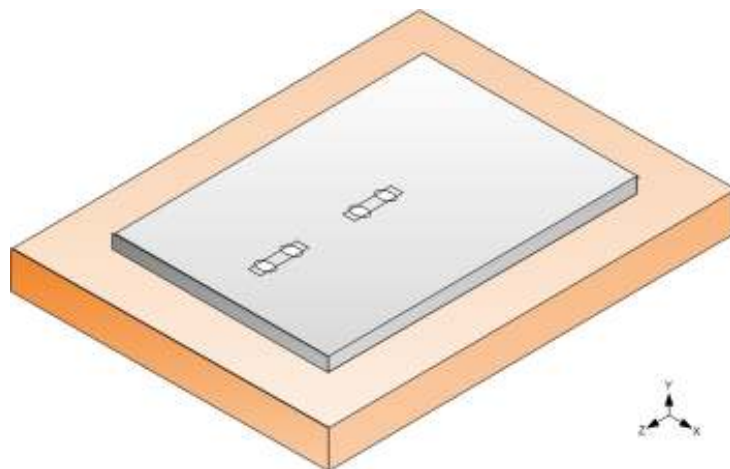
Posicionamento dos pontos de aplicação de carga.
